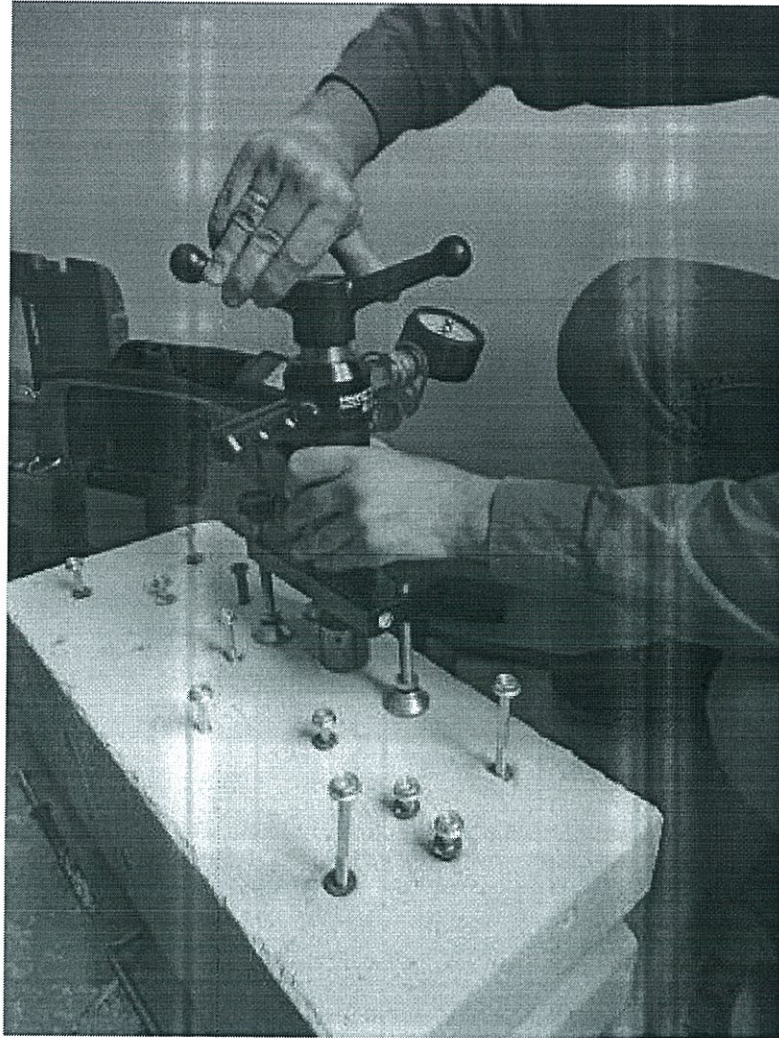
Испытание анкеров марки HRD, закреплённых в газобетонный блок
